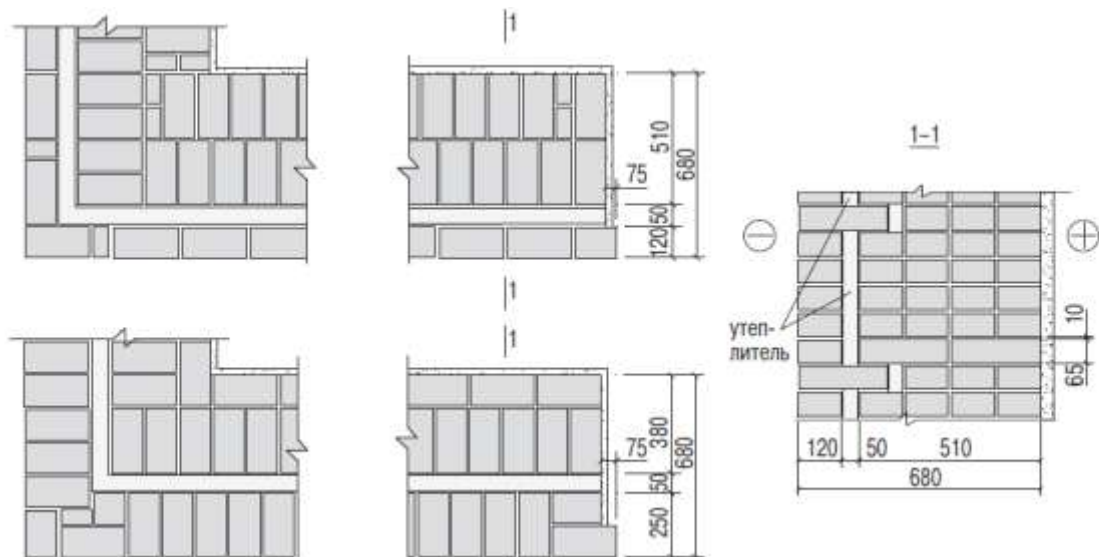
2.34б. Фрагменты стен из кладки с уширенным швом
